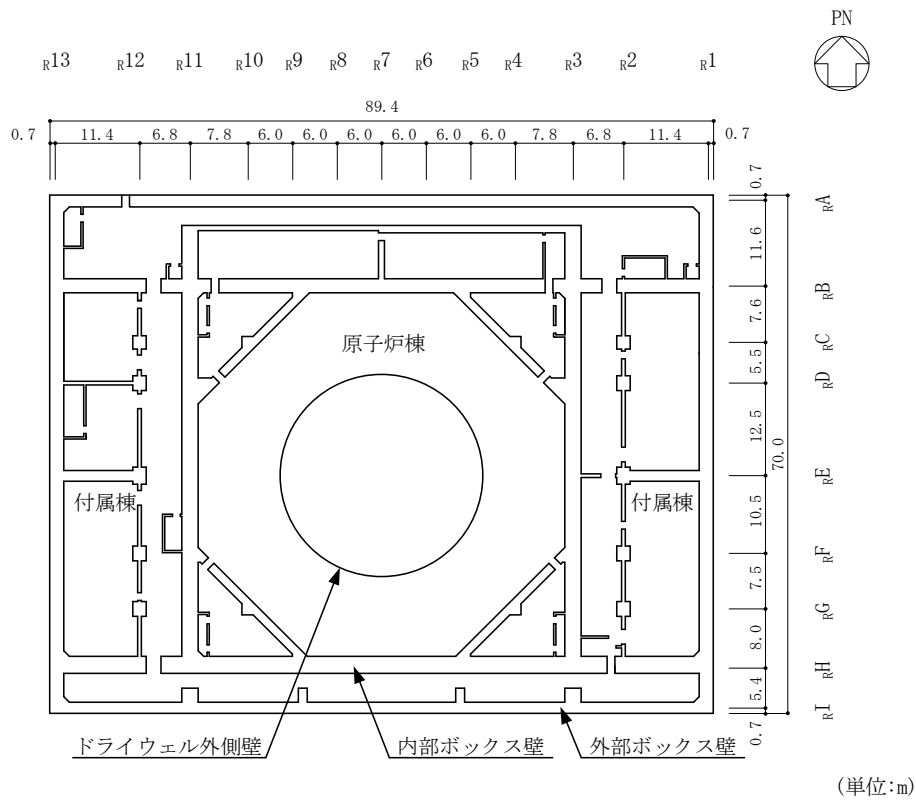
(1) 原子炉建物の概略平面図 (EL 1.3m*)
